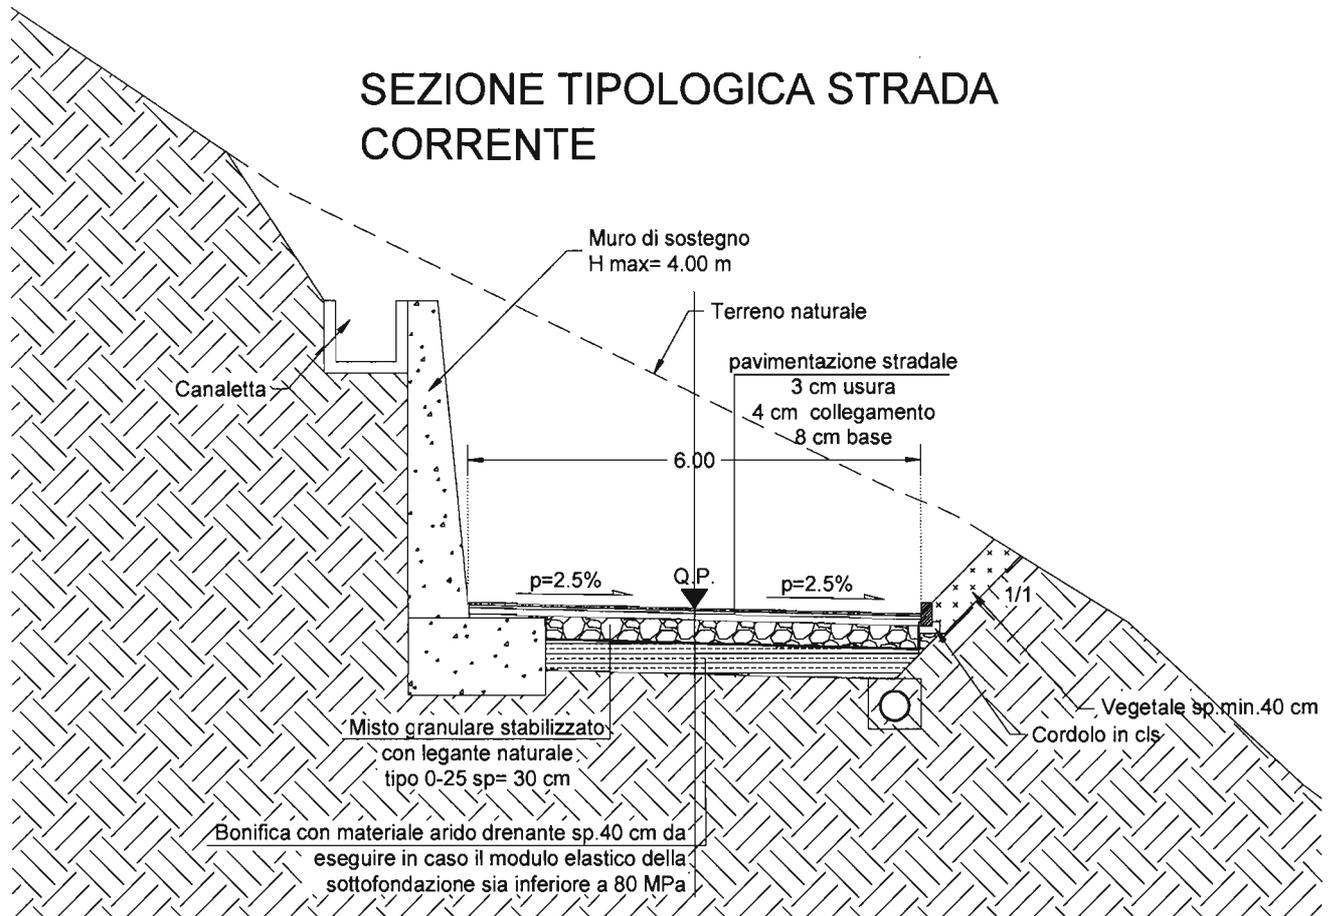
Sezione Tipo Strada Accesso Imbocco Gardena-Nord
